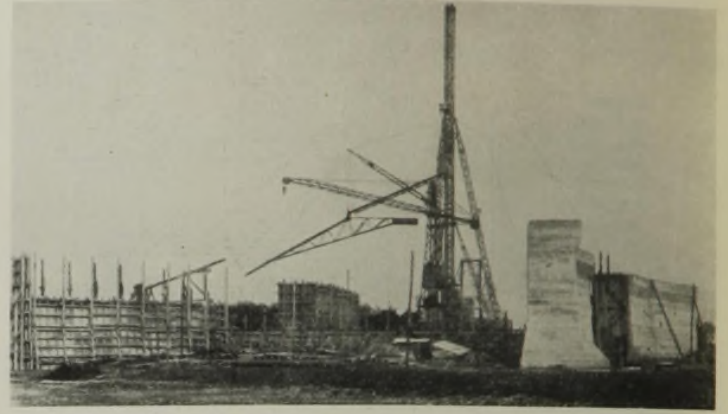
Lageplan der Kanalüberführung Klauke. Betonieren der Grundbauten.
